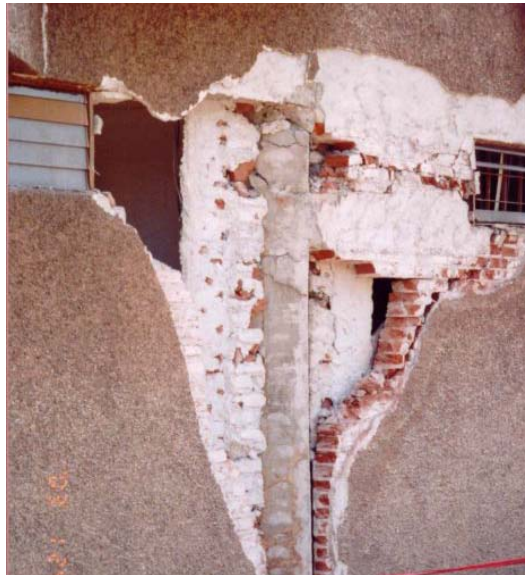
Daño de muros que hacían contacto con columnas giradas 45° en planta
